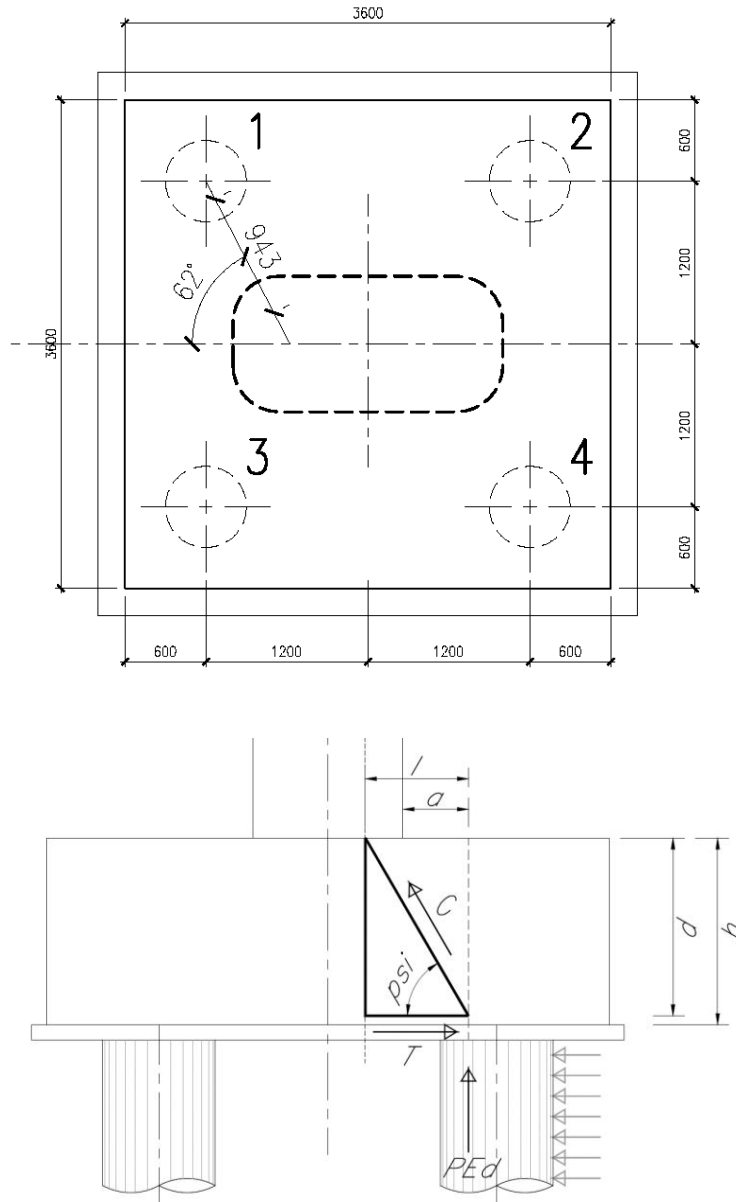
Tirante puntone - Biella compressa di calcestruzzo C e tirante di armatura T
